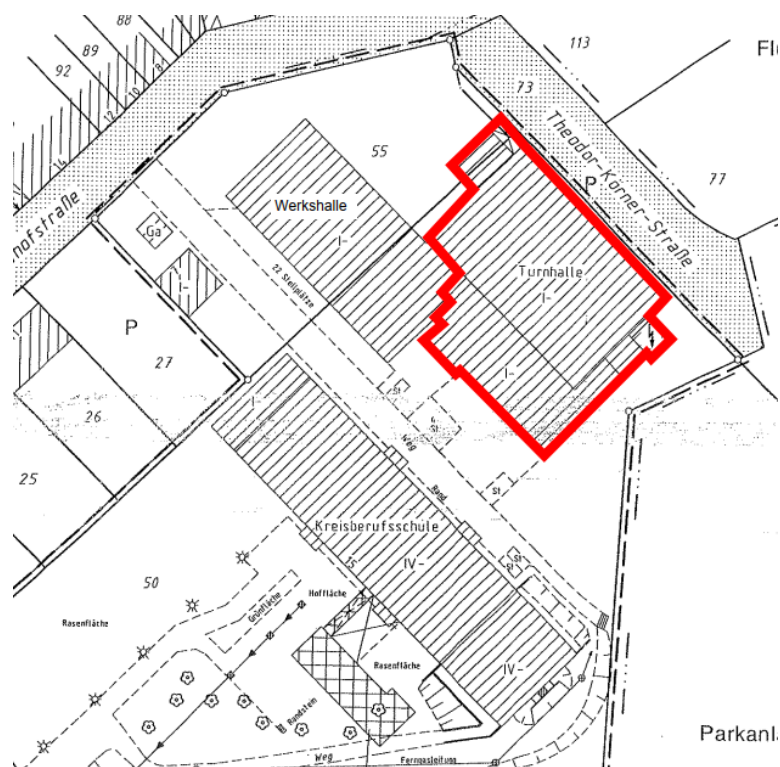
Lageplan, Ausschnitt der Planunterlagen der Baugenehmigung zur Errichtung eines Schulerweiterungsgebäudes mit offenem Verbindungsgang von 2007
